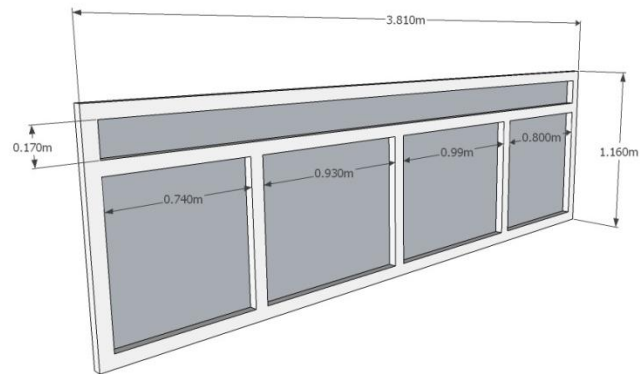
Ventana compuesta VC3. Primer piso, Fachada Norte.
